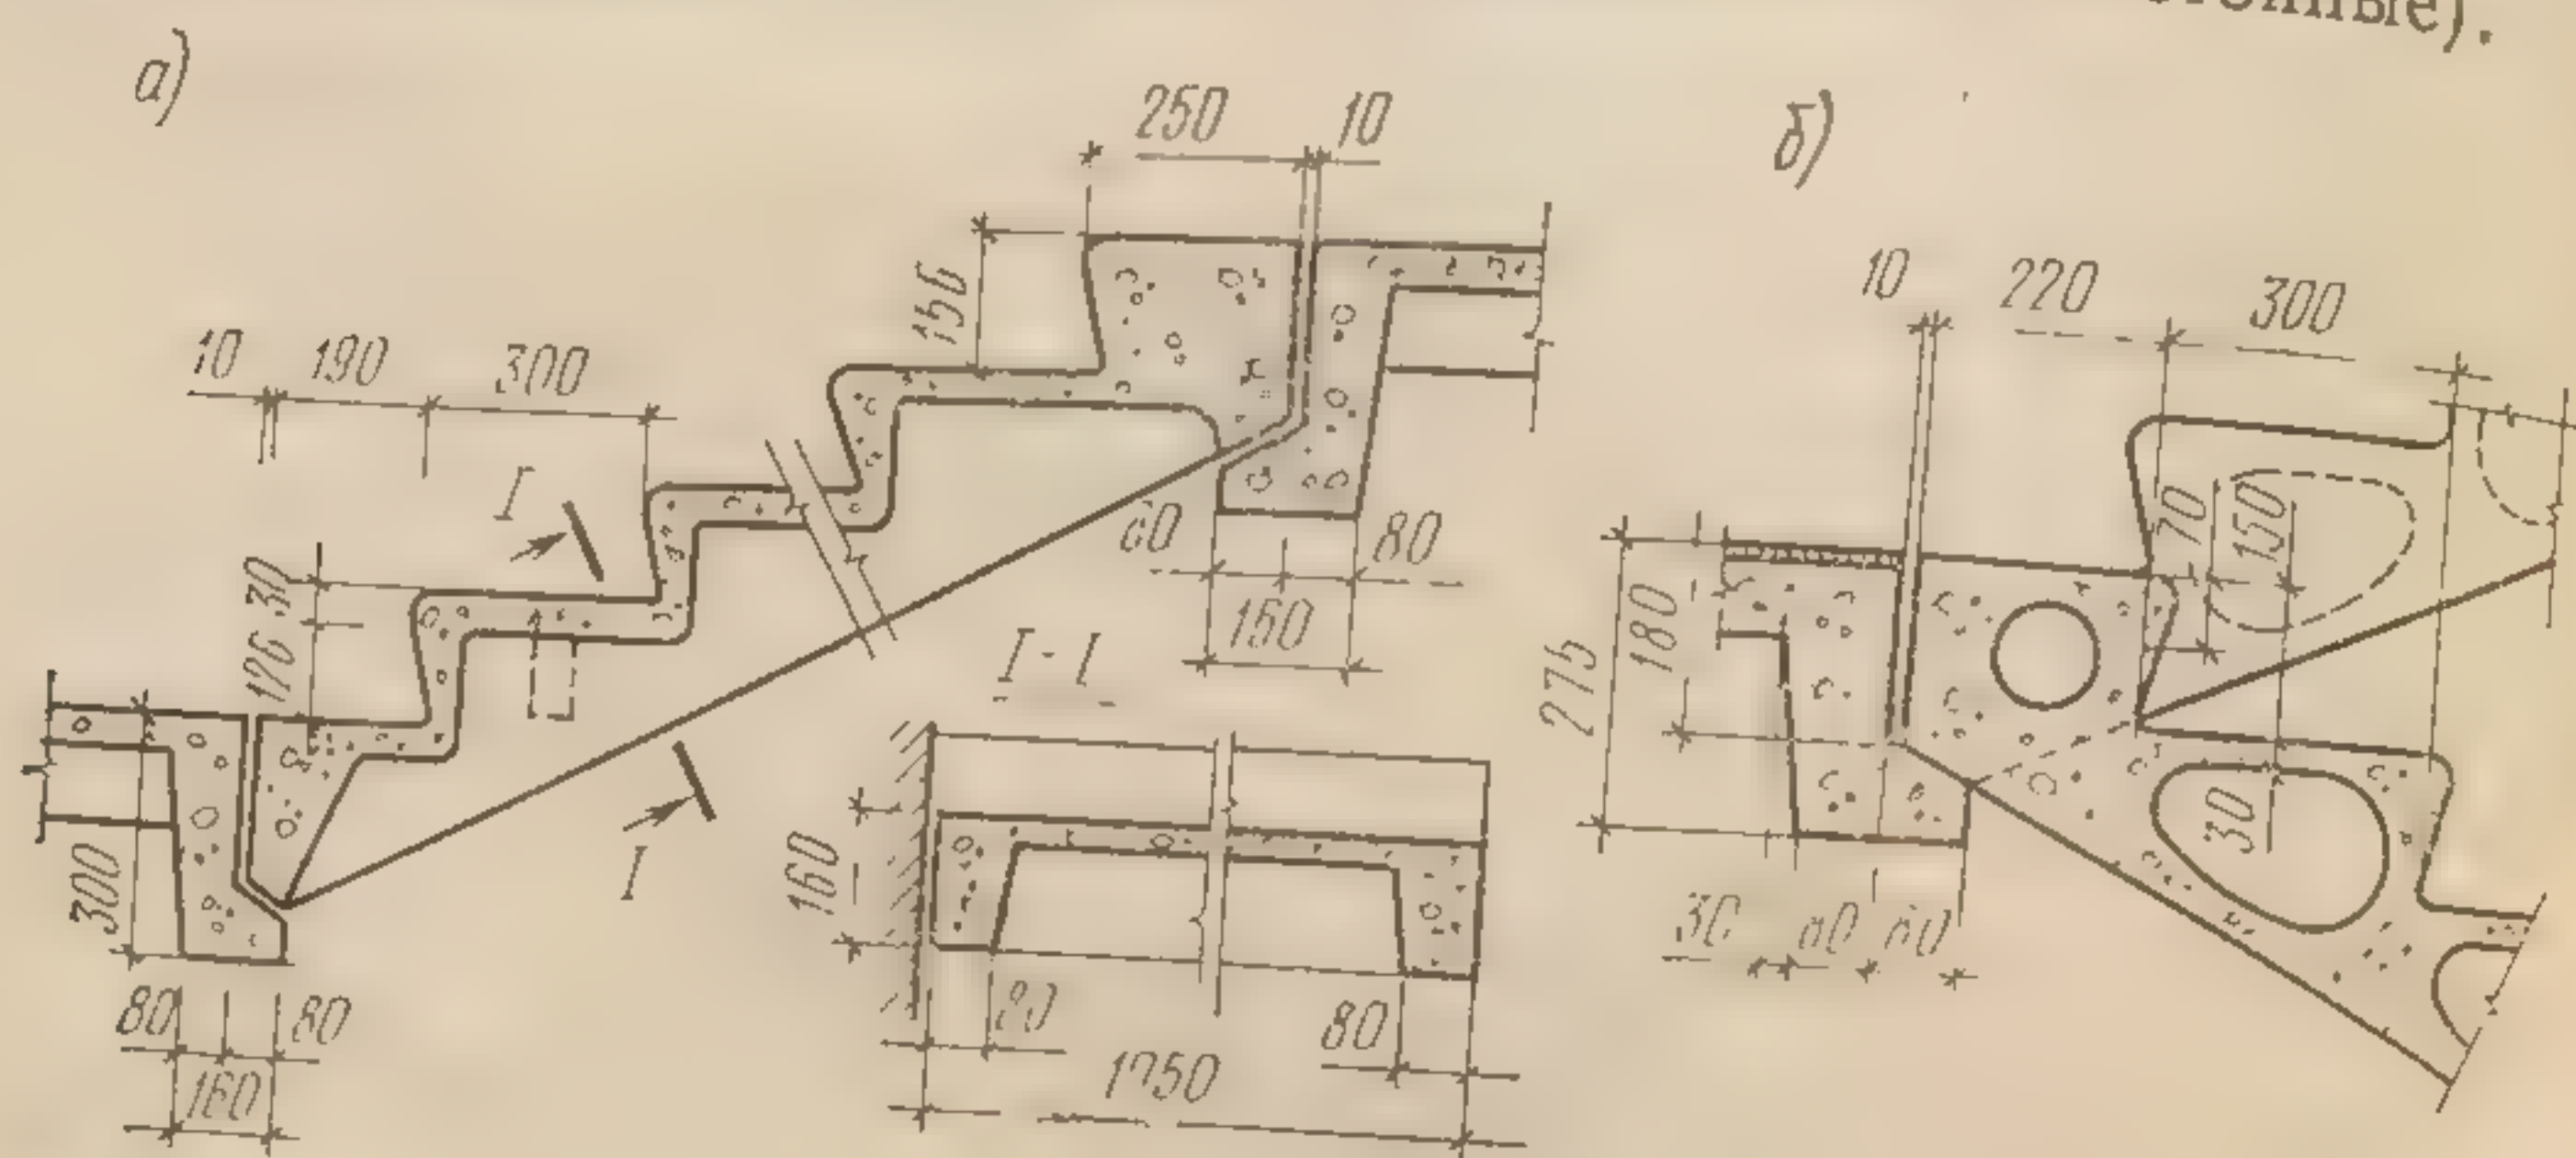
Сборные железобетонные лестничные марши со складчатыми и пустотелыми ступенями
